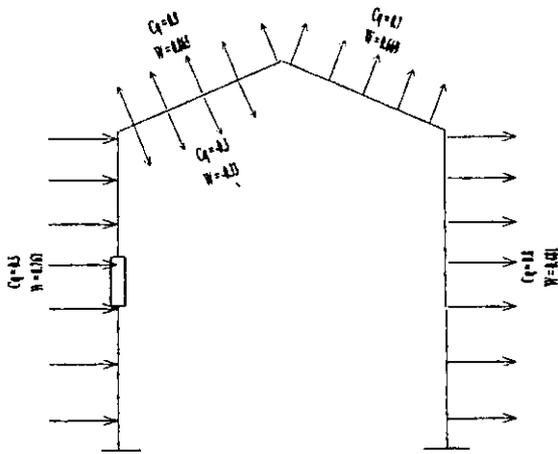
VIENTO TRANSVERSAL SUR-NORTE
